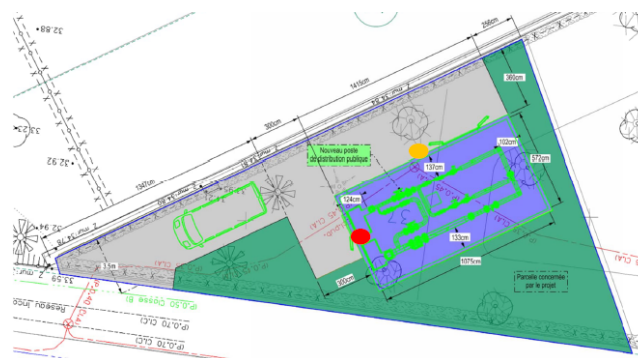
position prévisionnelle ventilation Haute (point orange) et Basse (point rouge) sur les murs du bâtiment
